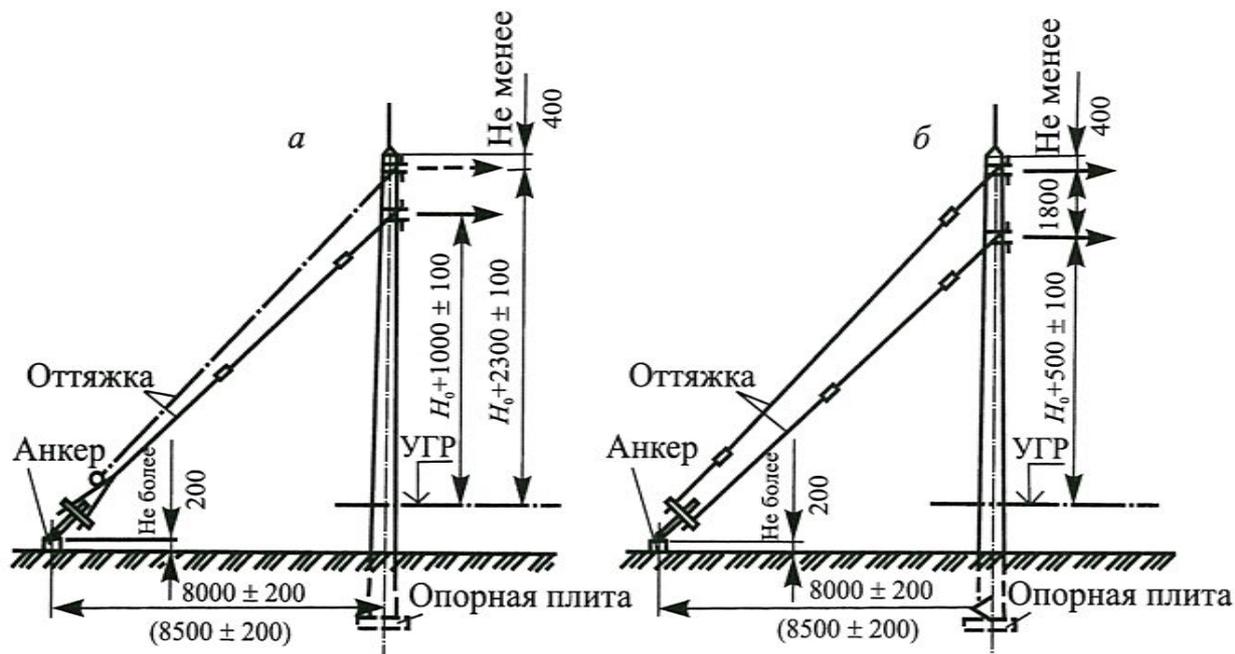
Схема установки анкерных оттяжек на железобетонных опорах:
